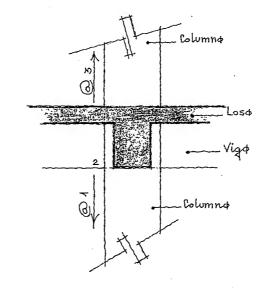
Columna (B), Nudo (2). Planta, (a).
